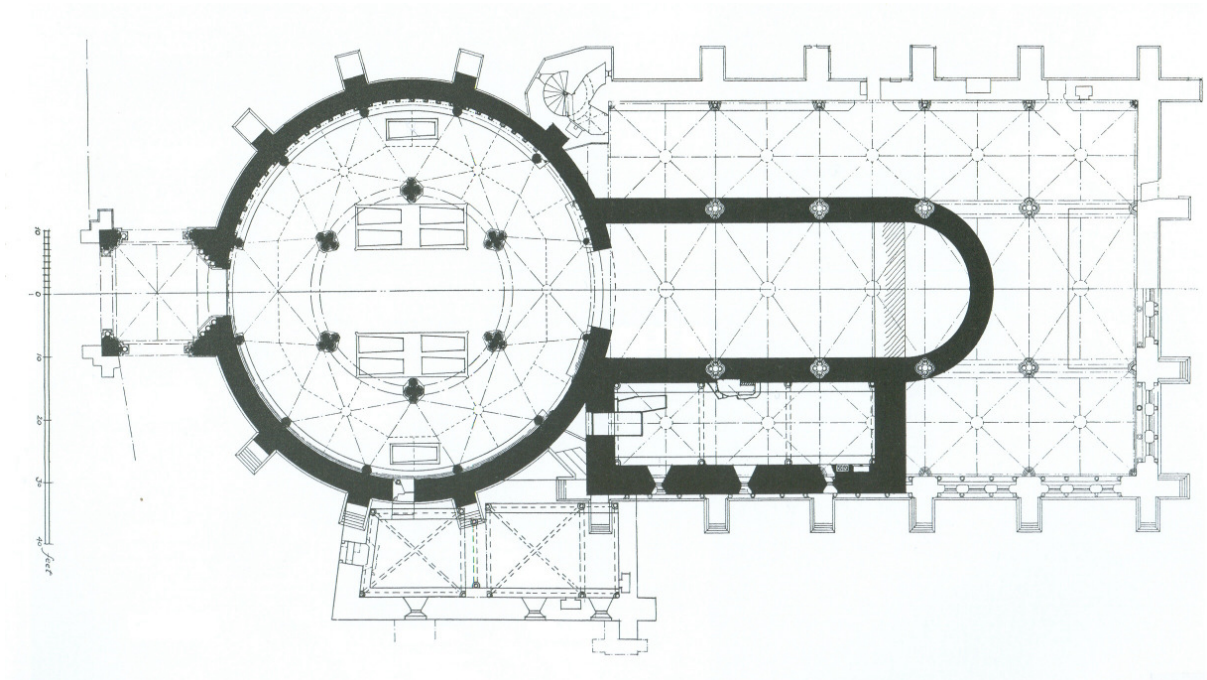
Grundriss des New Temple, London, 1185-1240.
